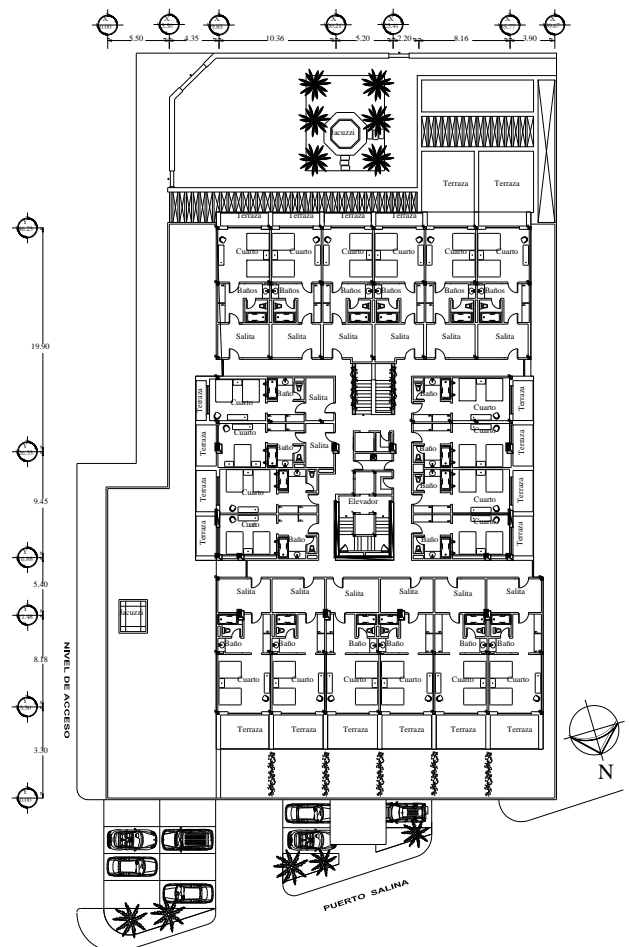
Planta Arquitectónica del 2do nivel.
